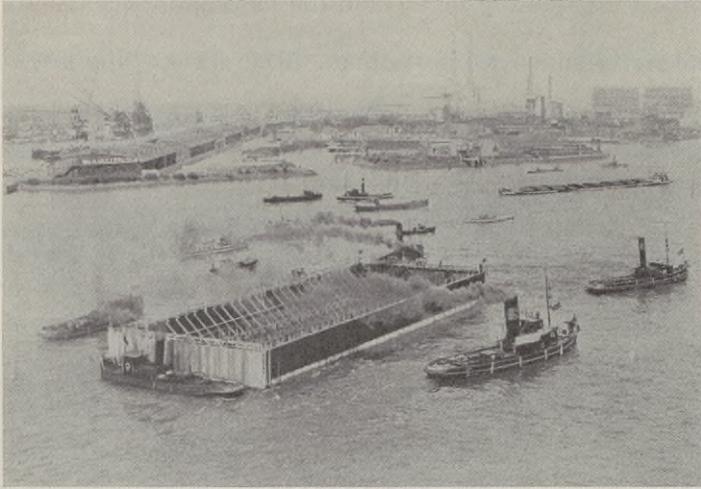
Schleppen eines Tunnelstückes nach dem Waalhafen.
